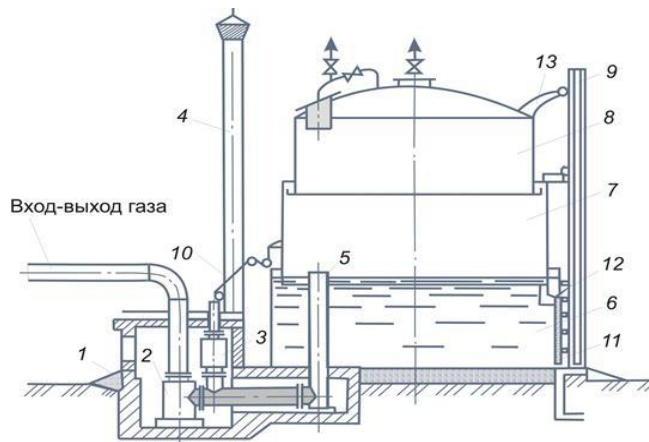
Схема мокрого газгольдера: 1 - камера газового введення (виведення) 2 - гідравлічний затвор; 3 - клапанна коробка автоматичного скидання газу 4 - труба скидання газу; 5 - газовий стояк; 6 - резервуар з водою; 7 – телескоп; 8-дзвін; 9, 11 - відповідно зовнішня і внутрішня напрямні; 10- підймальне пристосування; 12, 13- відповідно нижній і верхній ролики.
